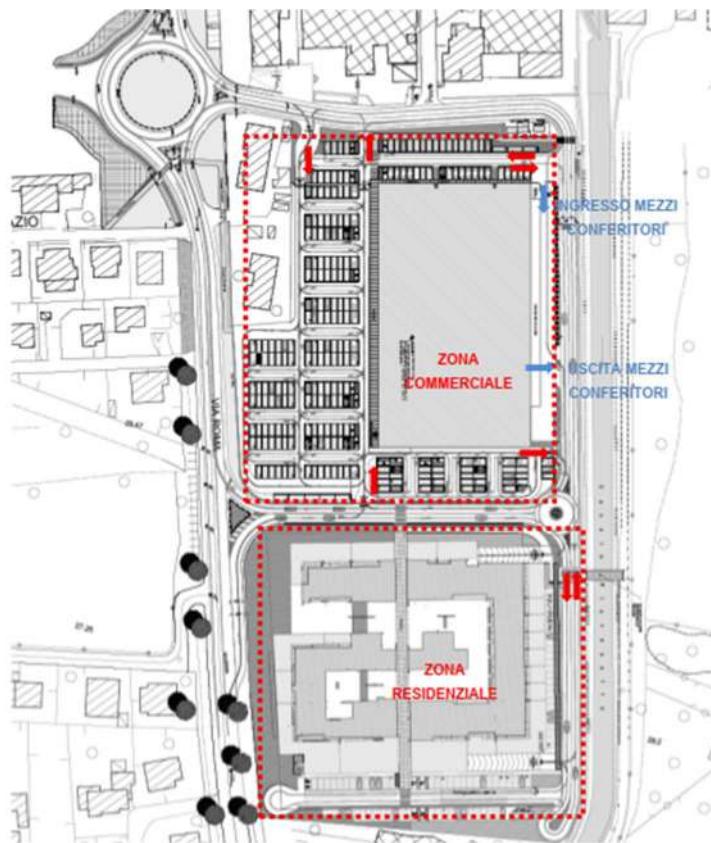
planimetria di progetto, Scenario 1 senza completamento bretella (estratto studio di impatto viabilistico redatto dalla società Transportotto Engineering).
